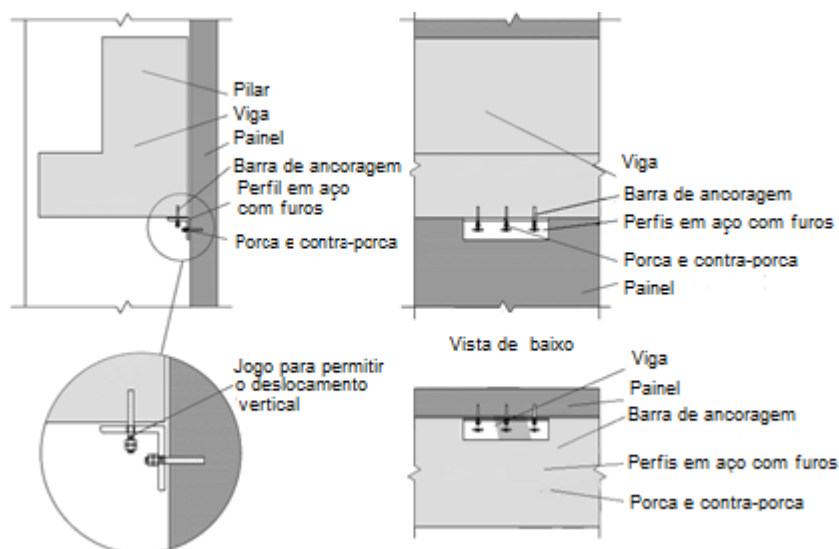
Exemplo de intervenção da ligação entre viga e o painel vertical [1]
